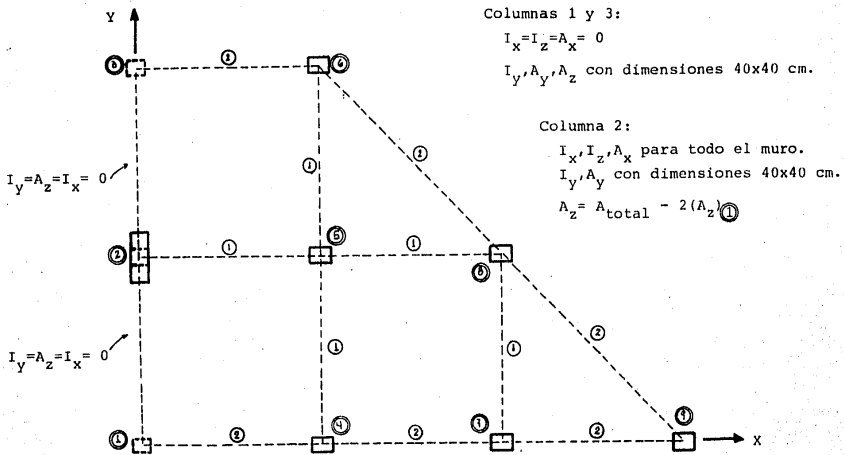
Ejemplo 2: modelo del muro de cortante para el análisis de la estructura.
